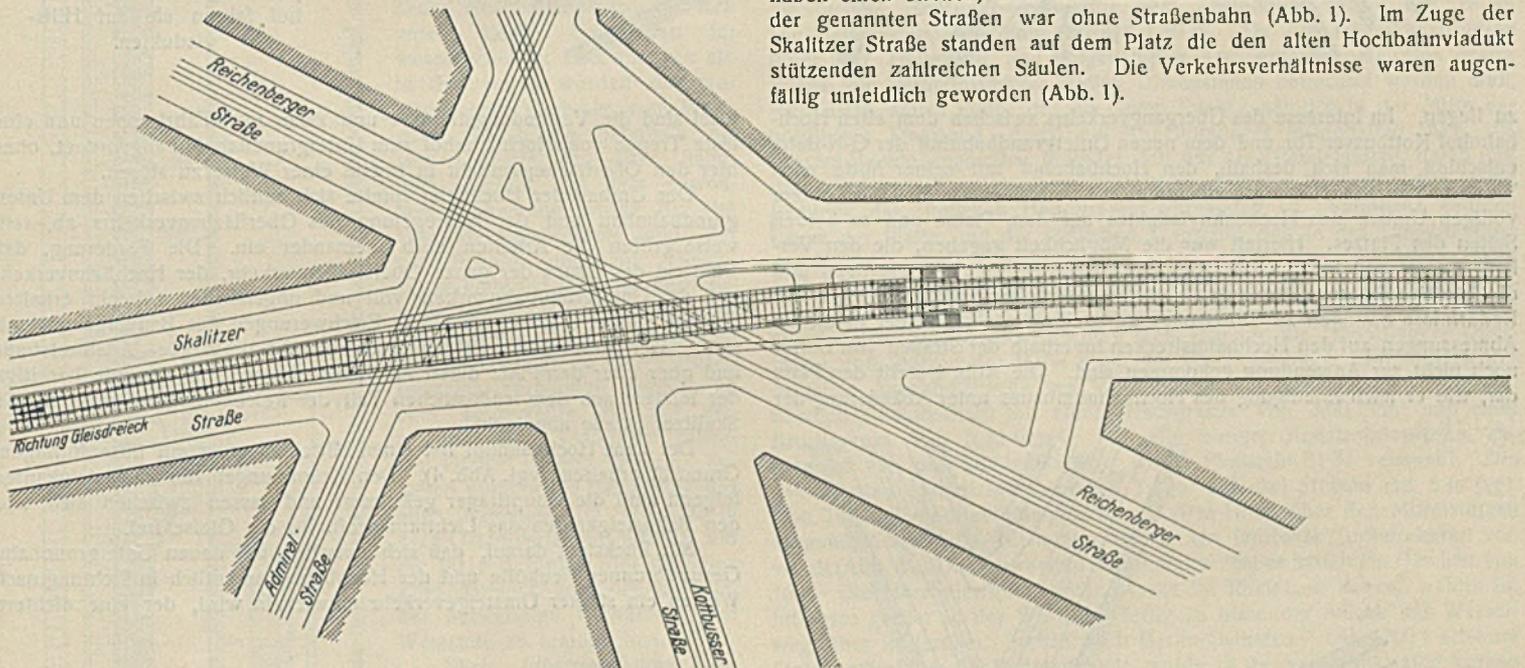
Lageplan des Platzes am Kottbusser Tor mit dem alten Hochbahnviadukt.
